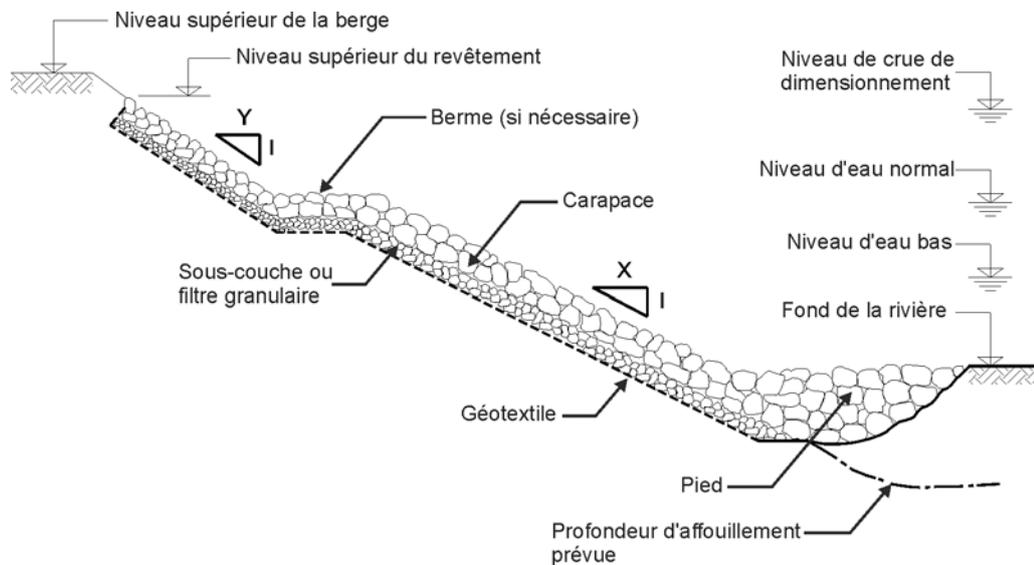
Éléments constitutifs d'un revêtement en enrochement classique
